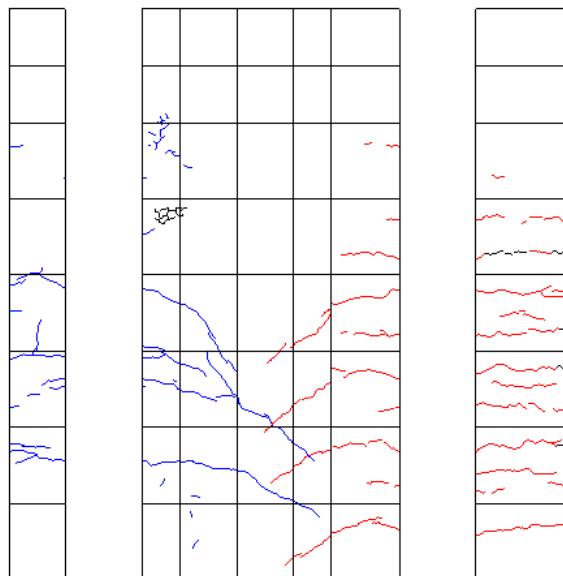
R=1/200 ひび割れ図
